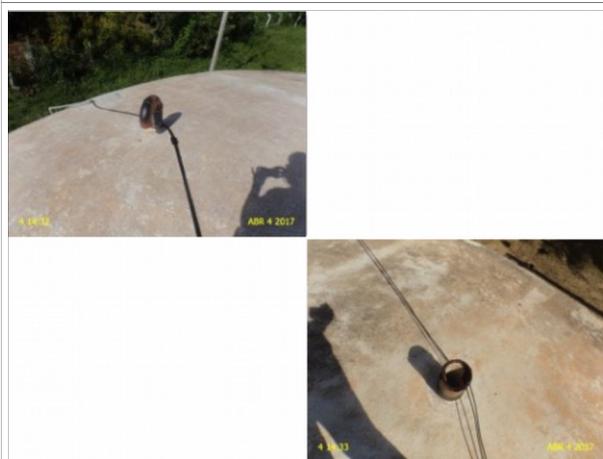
RAP-01: tubulações de ventilação sem tela de proteção.
